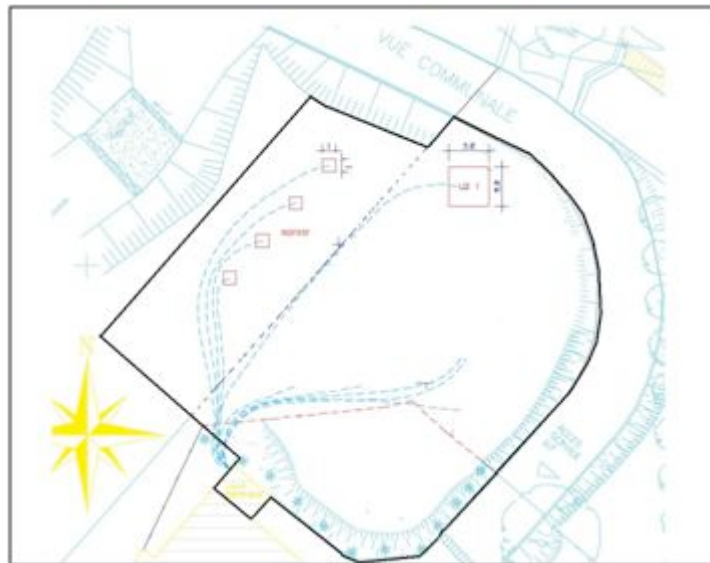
PLAN DU SITE EXPERIMENTAL (IUT SAINT-PIERRE)
